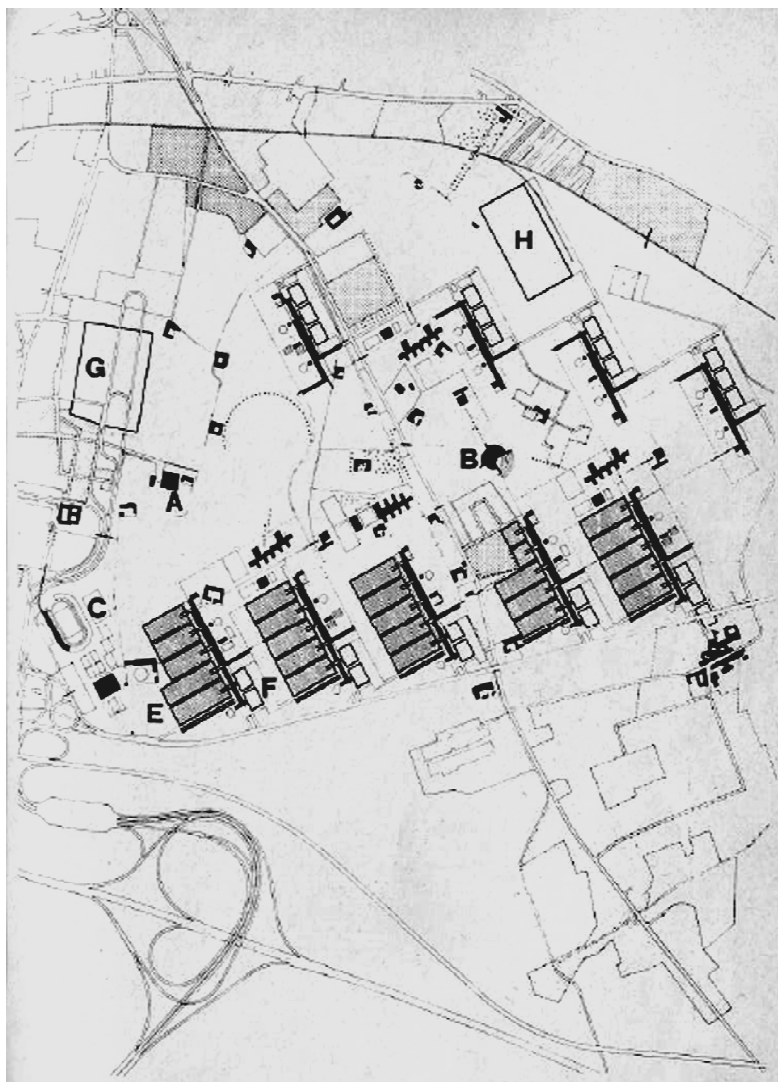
Planimetria generale di San Polo disegnata da L. Benevolo
